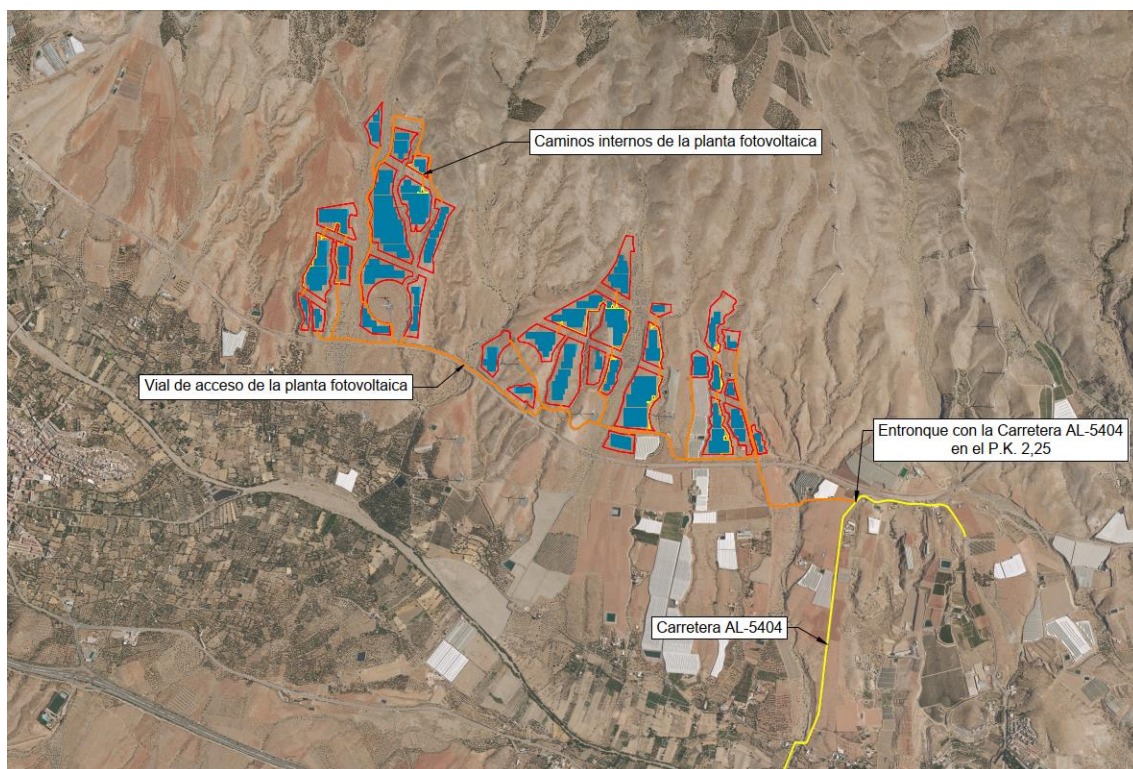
Detalle de acceso y caminos internos de la planta fotovoltaica. Fuente: Elaboración propia
